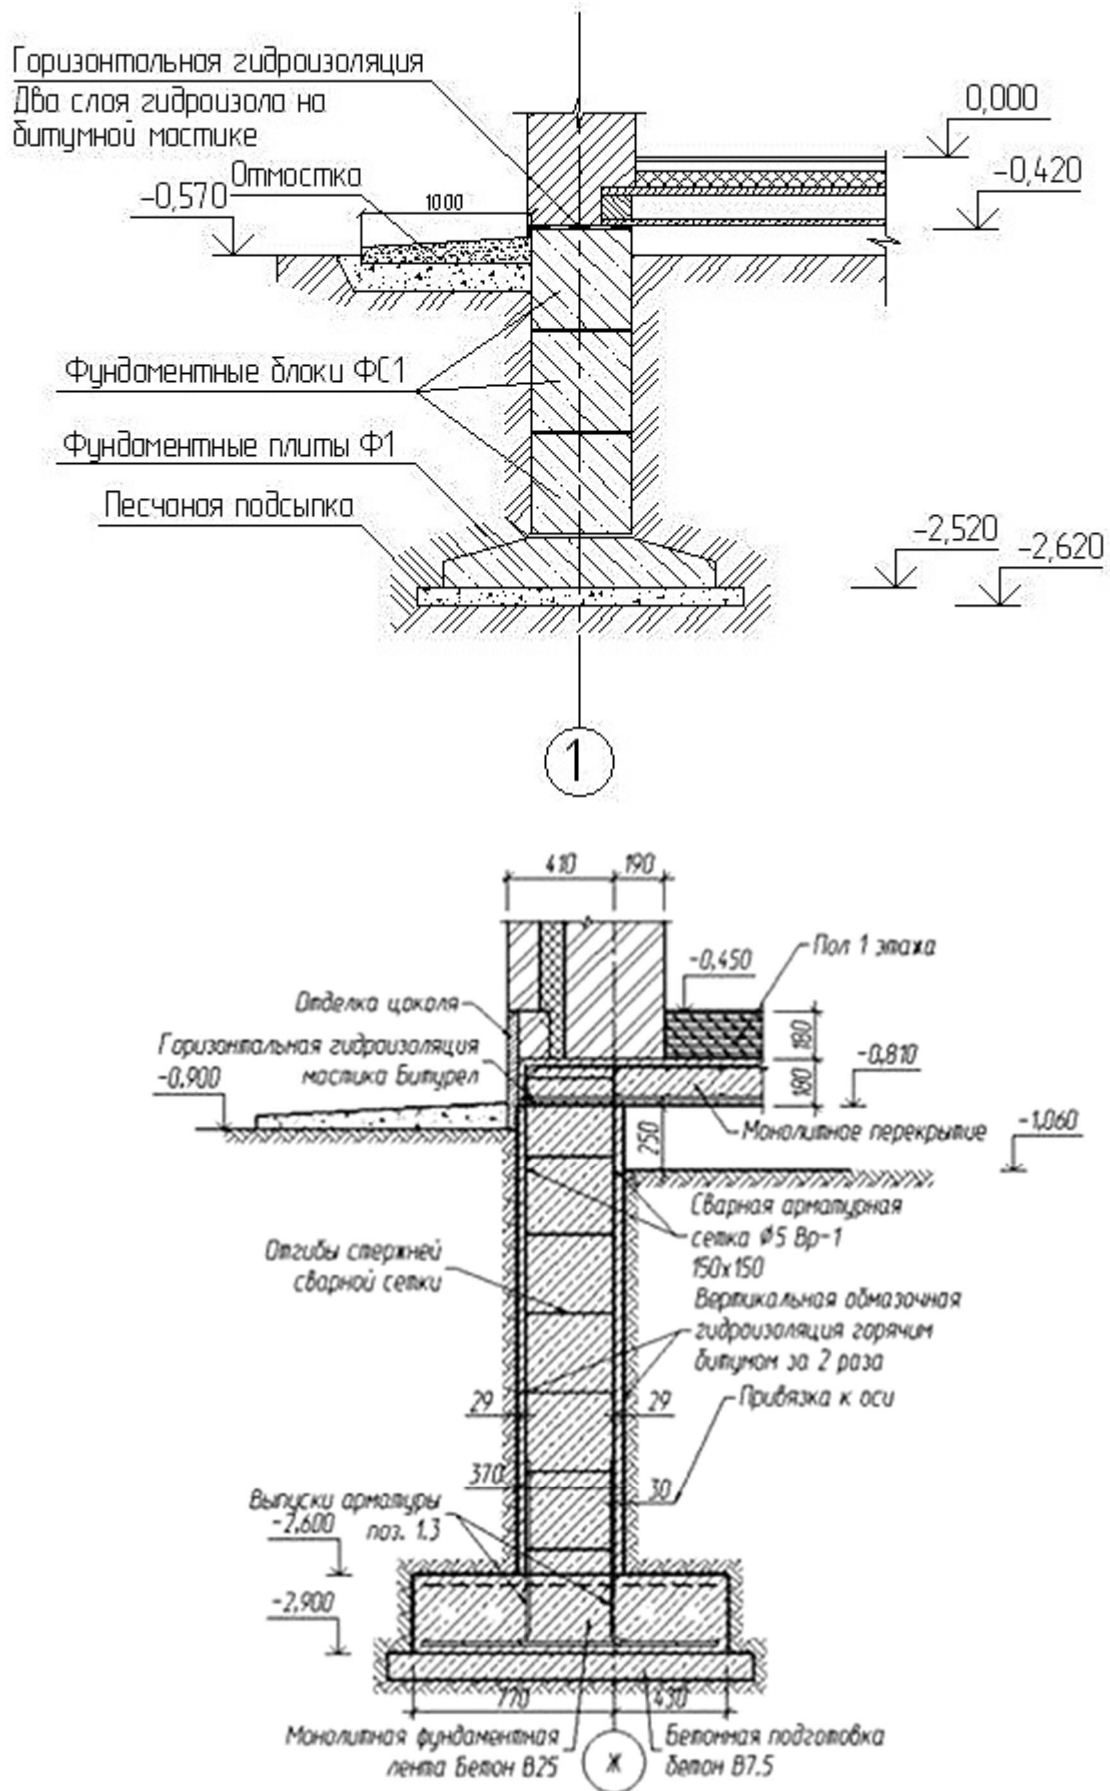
Вариантные решения сборного ленточного фундамента под наружную кирпичную стену
